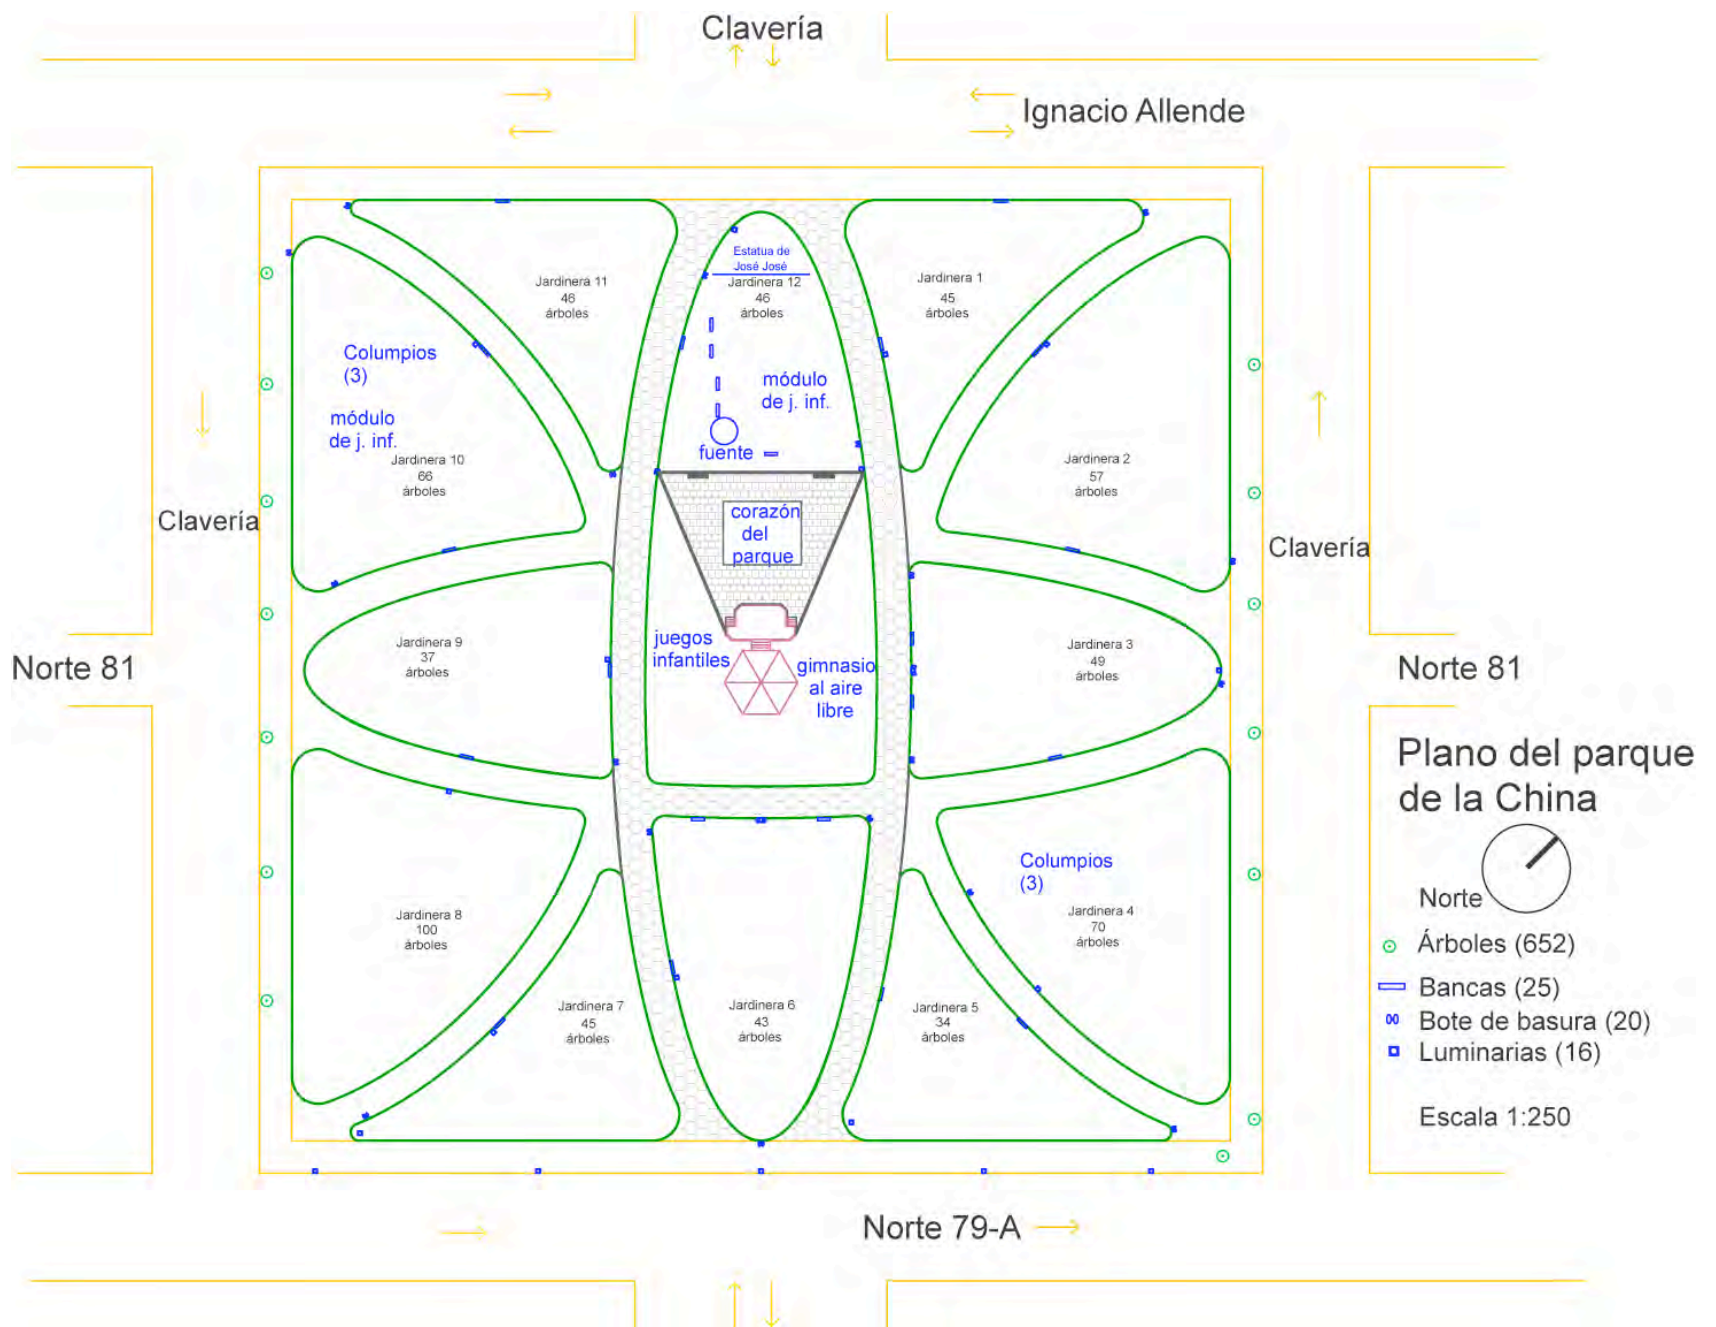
Plano del parque de la China. Elaborado por la autora con AutoCAD.
